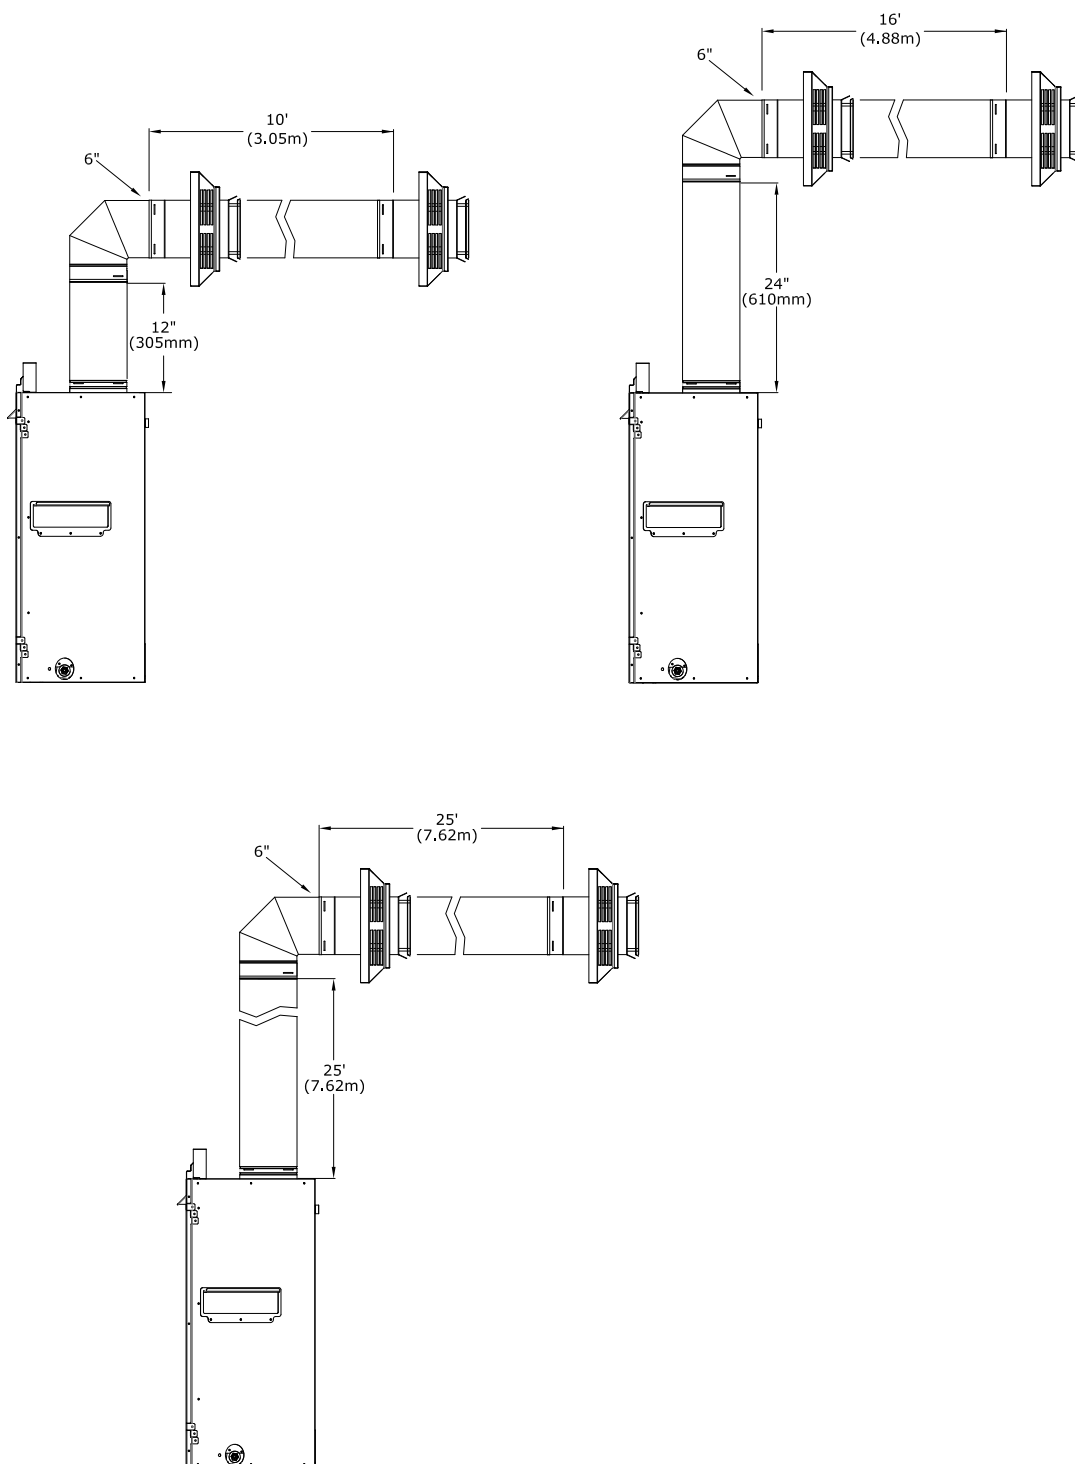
Conduit 4"x6-5/8" à terminaison horizontale
